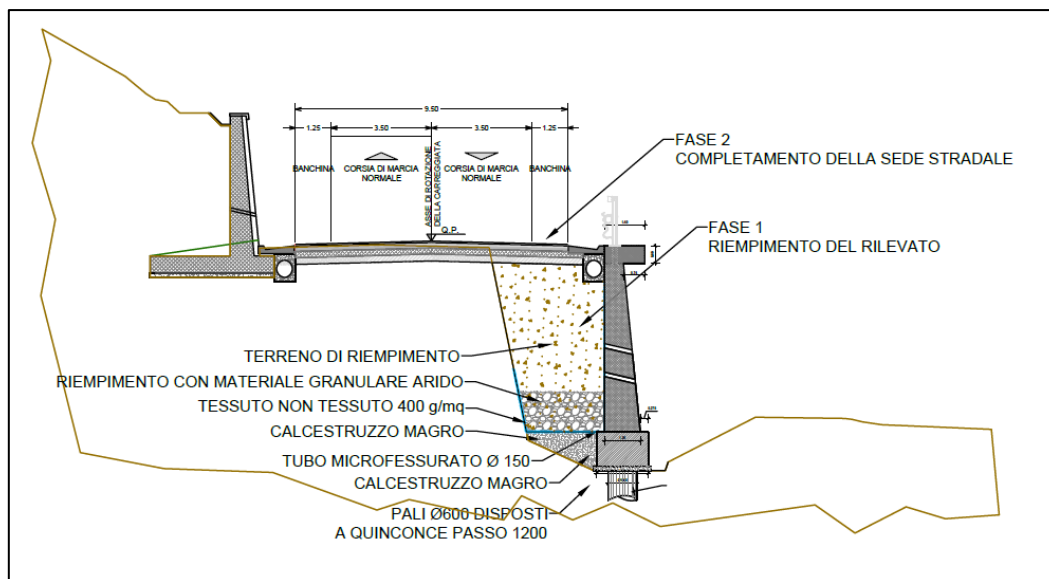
Sezione tipo 2 – Allargamento lato valle con muro su pali
